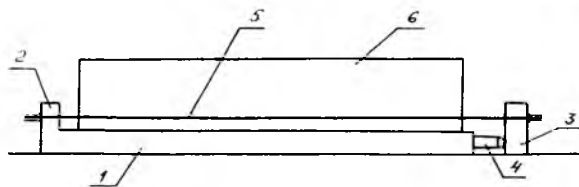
Схема группового натяжения стержней 1 — силова́я форма; 2 — неподвижный упор; 3 — подвижный упор; 4 — гидродомкрат; 5 — напрягаемая арматура; 6 — бетонизируемая конструкция
